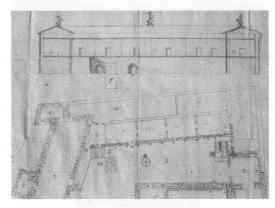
Alzado de la escalera principal de acceso zona de poniente y mediodía y puertas [13] y [14] de acceso a la parte baja zona G. (Aguas s.a, 3)
